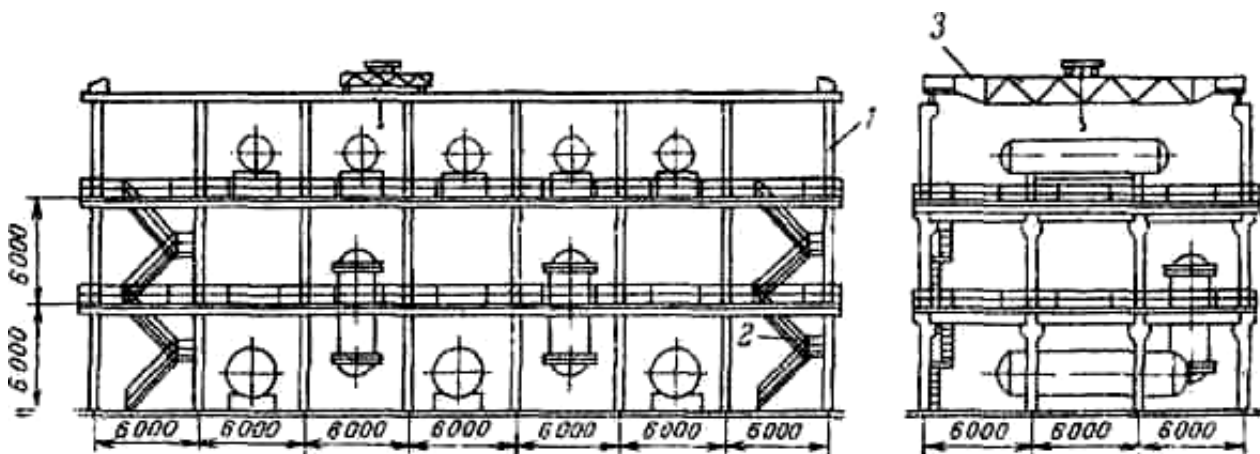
Постамент із збірного залізобетону (етажерка):
